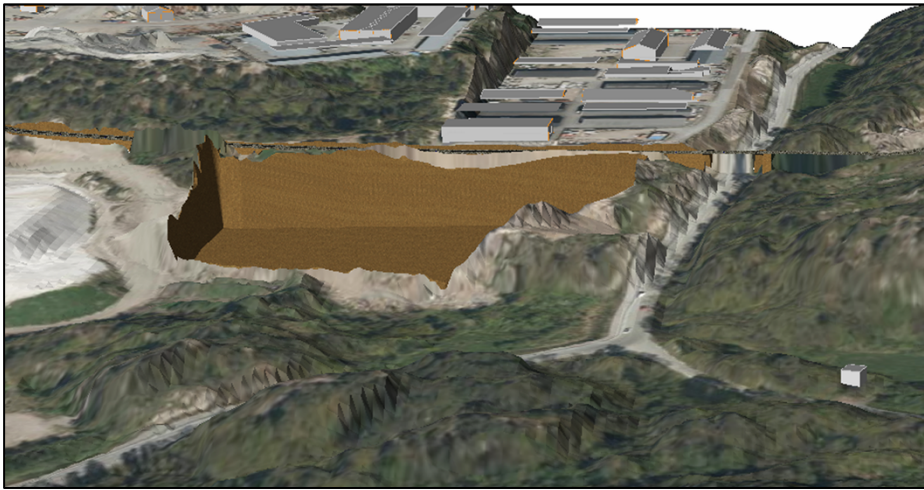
BI5 (Øvrige anlegg) planert til kote +30. Rød stiplet linje er omrisset av delområde BI5. (Kilde TT Anlegg)
